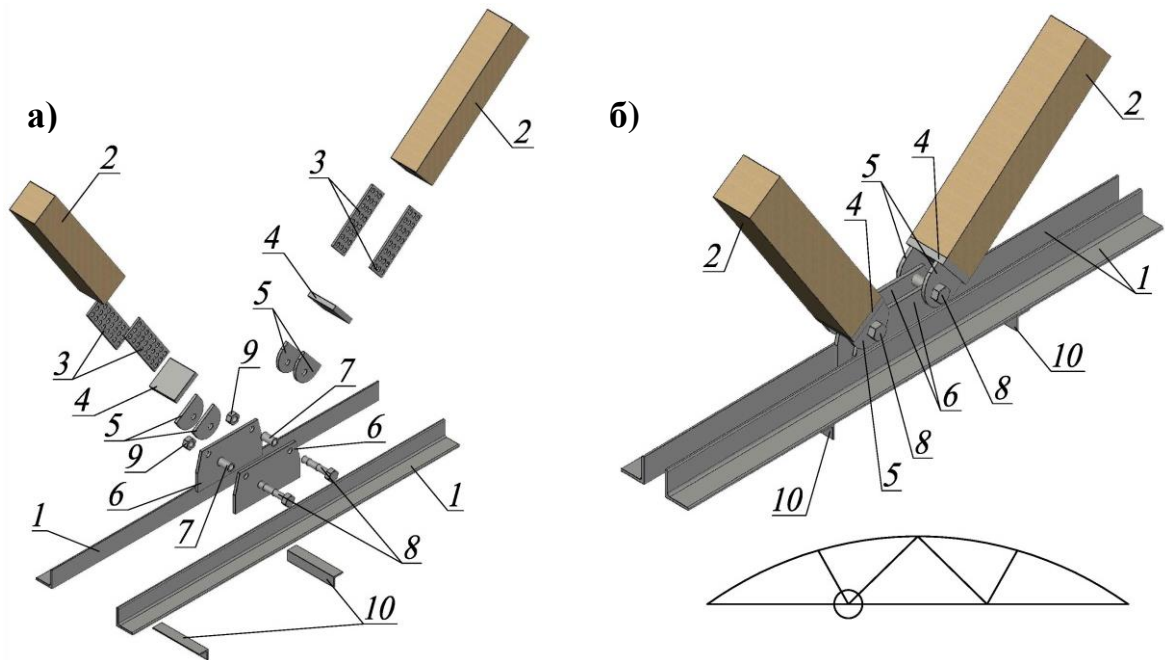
Узел соединения раскосов с металлическим нижним поясом в разобранном (а) и собранном (б) виде: 1 – элемент нижнего пояса; 2 – раскос; 3 – плоский стержень; 4 – распределительная пластина; 5 – проушина; 6 – фасонка; 7 – трубка; 8 – болт; 9 – гайка; 10 – распорка
